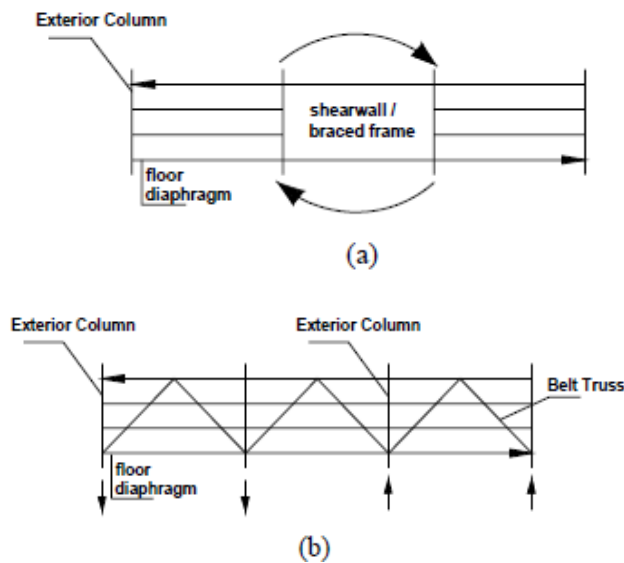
6 Transfer Gaya dalam Sistem Outrigger Truss Yang Konvensional
